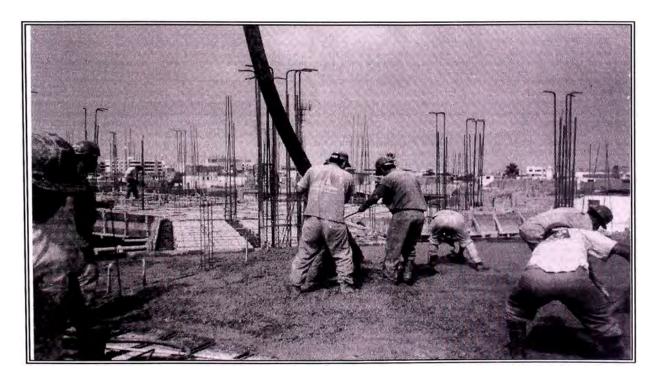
Vaciado de concreto premezclado en Losa Aligerada – 3er Nivel
